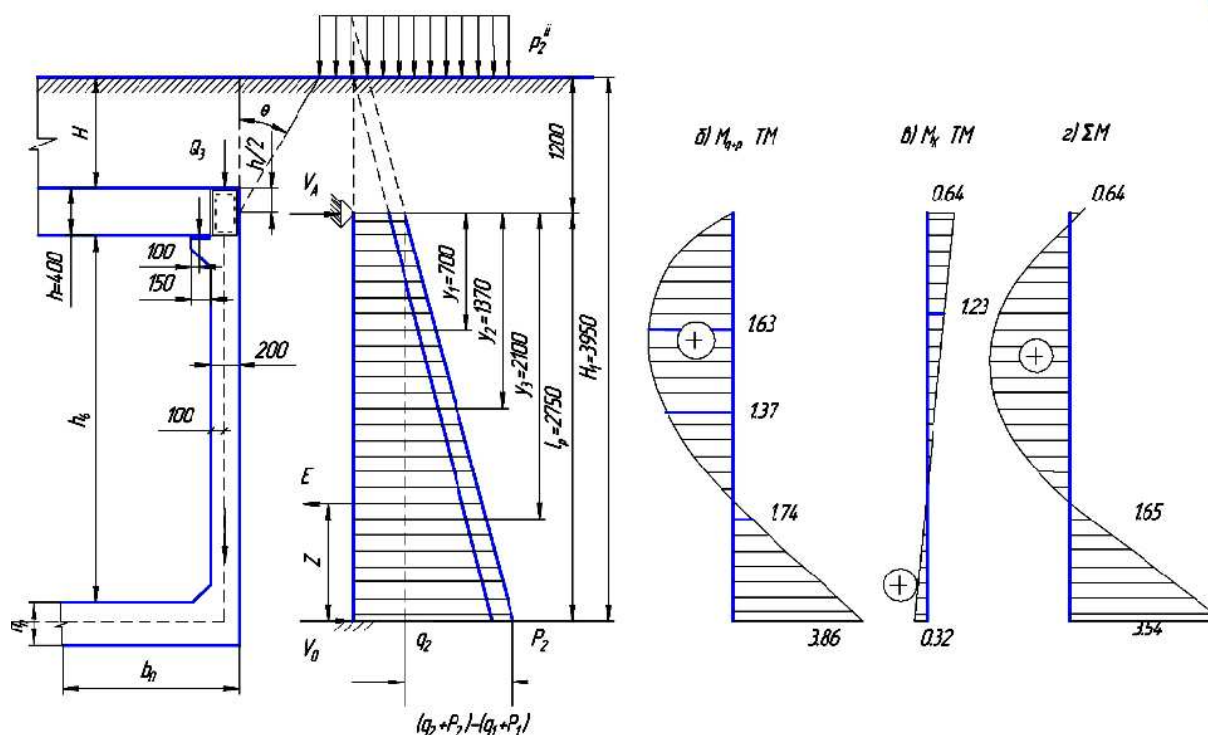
Схемы к расчету вертикальной стенки тоннеля
